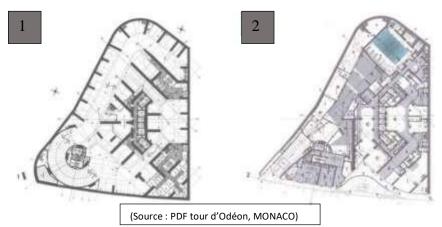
vues sur les plans de la tour : plan du 1er et 2ème étage
